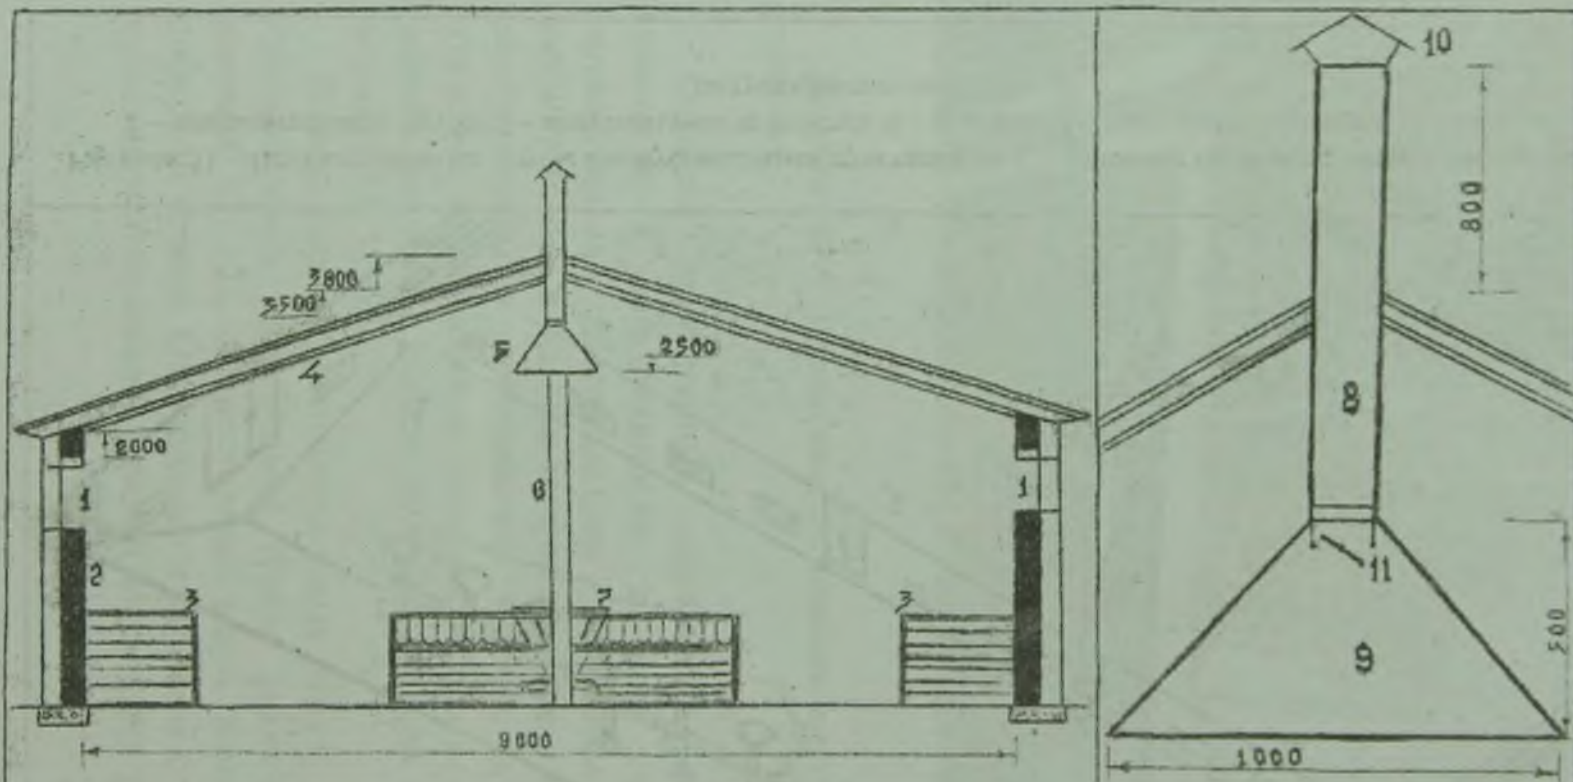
Расположение и устройство вентиляционных шахт с естественным побуждением воздуха в родильном отделении. 1 – оконный проём; 2 – утеплённая стена; 3 – щит пристенной клетки; 4 – утеплённое перекрытие; 5 – конусовидная приставка; 6 – опорный столб; 7 – 4-сторонняя кормушка с клетками; 8 – вытяжная труба; 9 – конусовидная приставка; 10 – козырёк.
